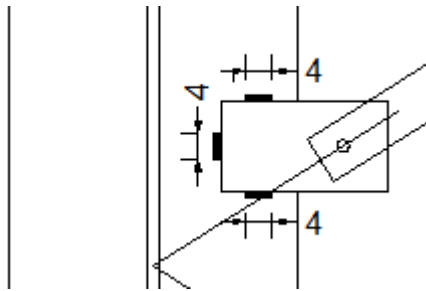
Soldadura de filete entre patín inferior de viga y placa
